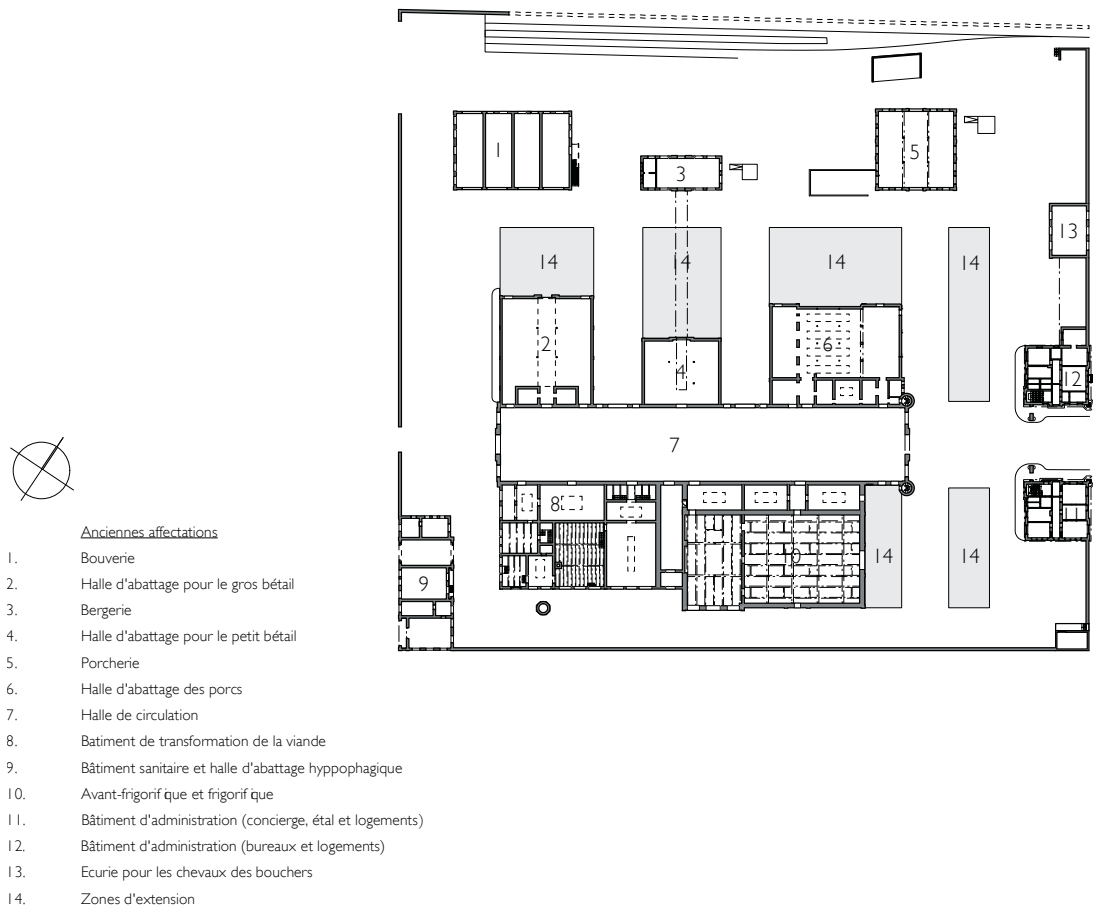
Plan des abattoirs de la Chaux-de-Fonds (Matthey-de-l'Endroit & Pochon : 101)
